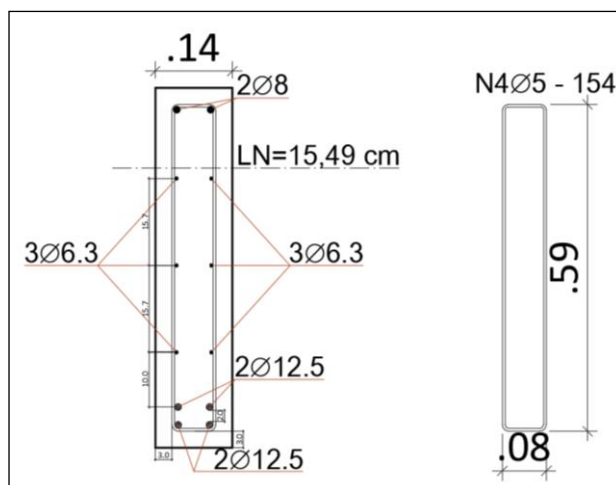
Detalhamento da viga com dimensão 14x65 cm, dimensionada para concreto de 30 MPa.
